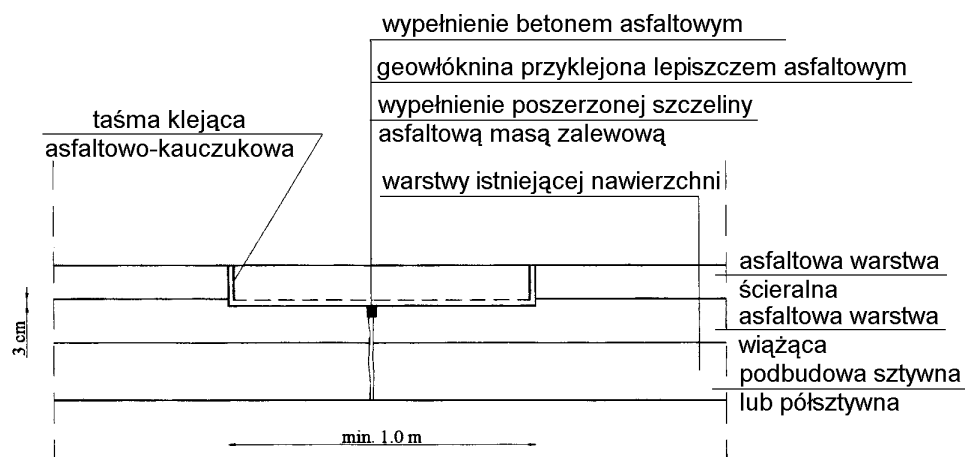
Wzmocnienie silnie uszkodzonej nawierzchni z betonu cementowego warstwami asfaltowymi
